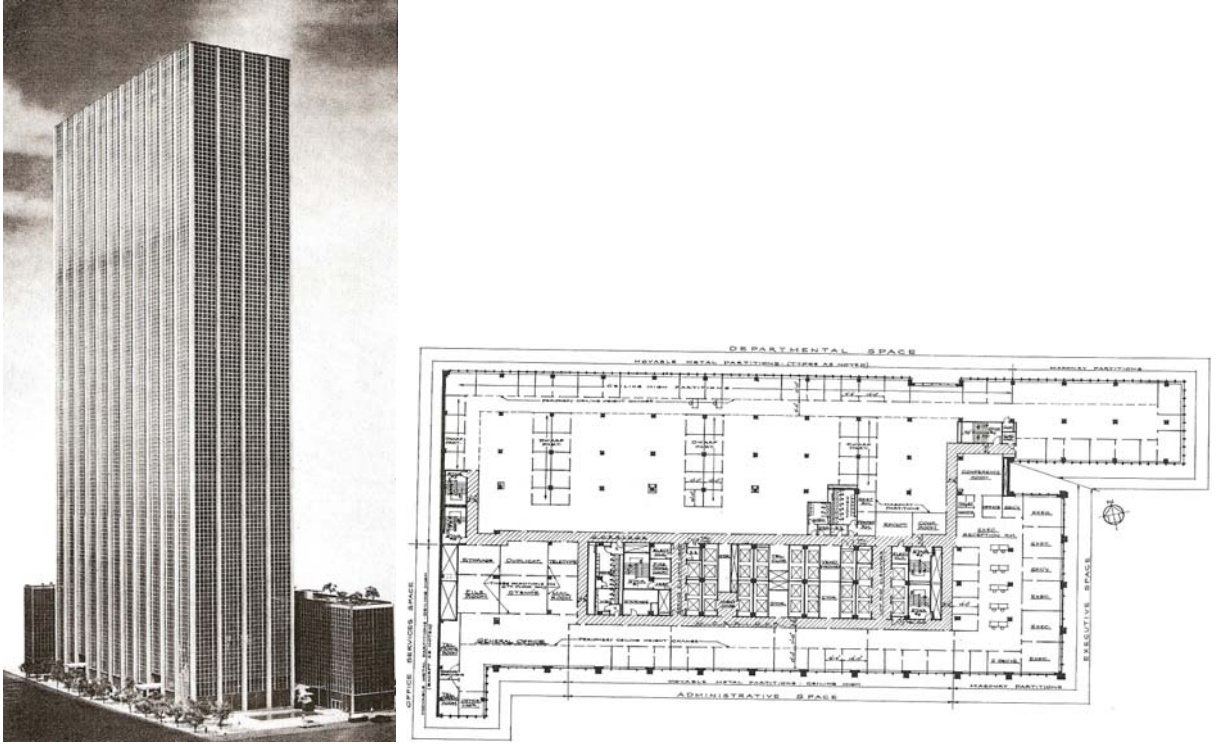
American Cyanamid binasının planı ve fotoğrafı (Rippen, 1960)
